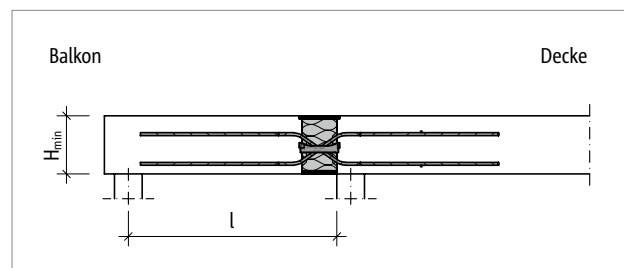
Schöck Isokorb® XT Typ QL-VV: Statisches System (XT Typ QL-VV5 bis VV8)
